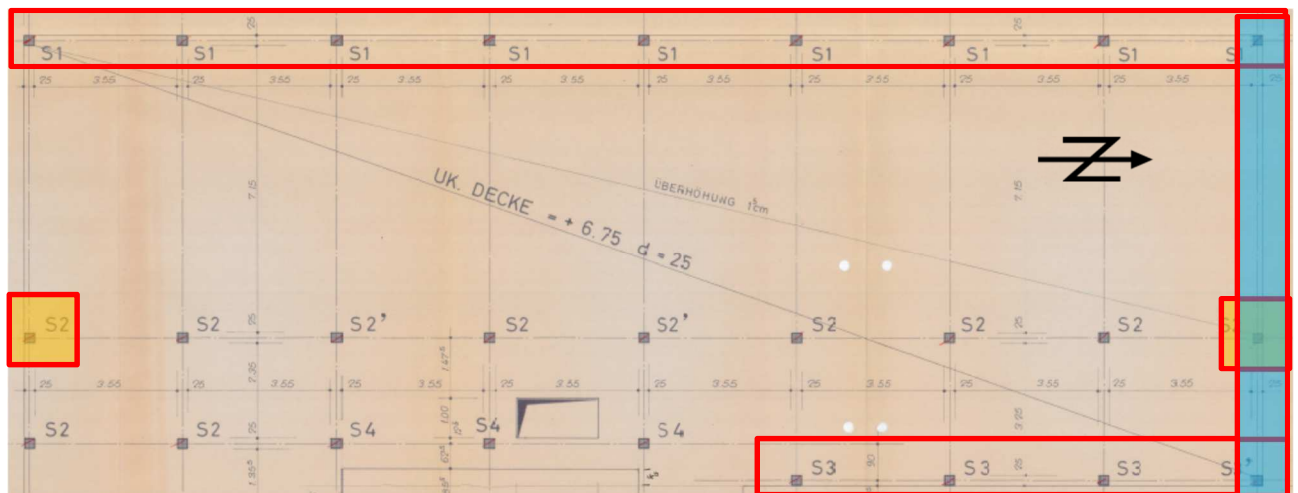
Grundriss OG. Der Durchstanzwiderstand der markierten Stützen ist nicht gewährleistet.
